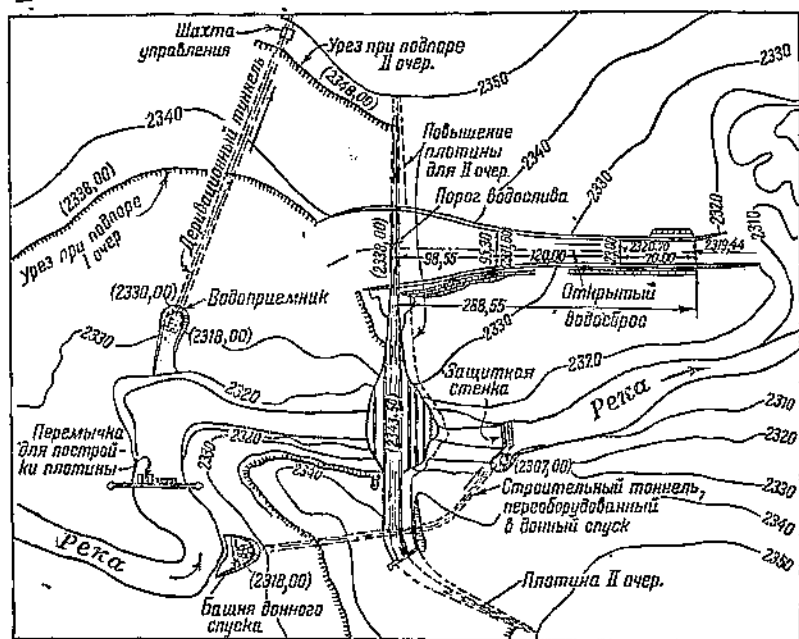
Схема гидроустановки с водохранилищем в верхнем бьефе и напорной деривацией в виде тоннеля.
